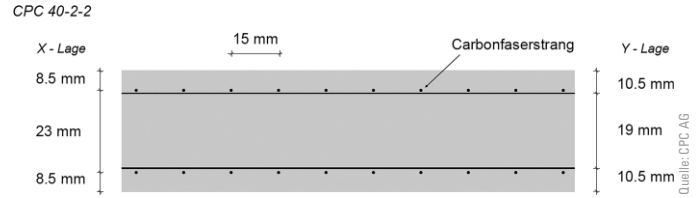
Plattenquerschnitt einer 40 mm dicken CPC-Platte
